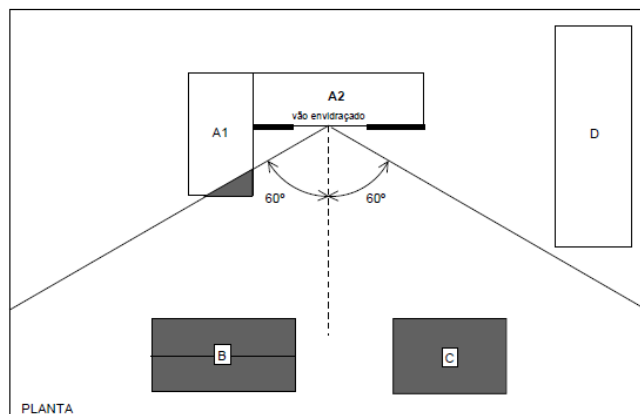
7 - Exemplo de cálculo do ângulo de horizonte em planta [7]
